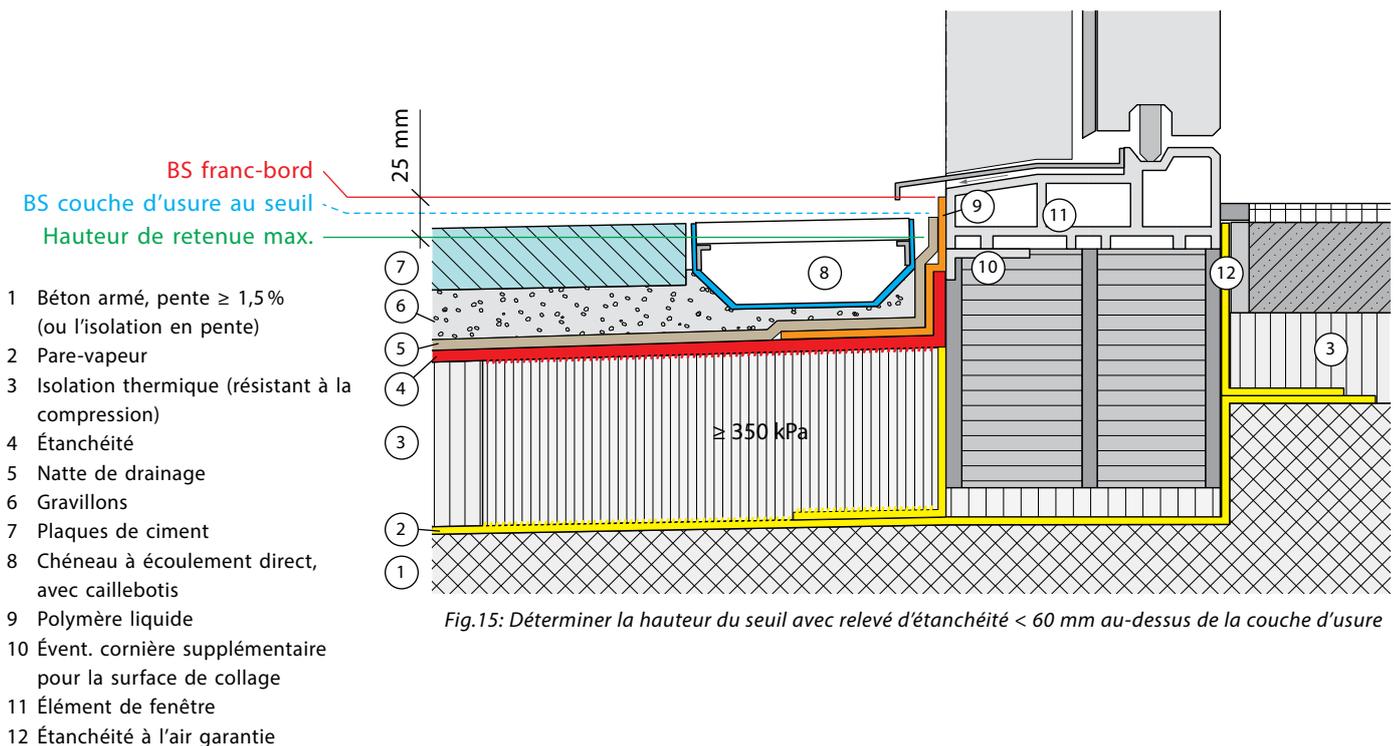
Déterminer la hauteur du seuil avec relevé d'étanchéité  $< 60$  mm au-dessus de la couche d'usure
